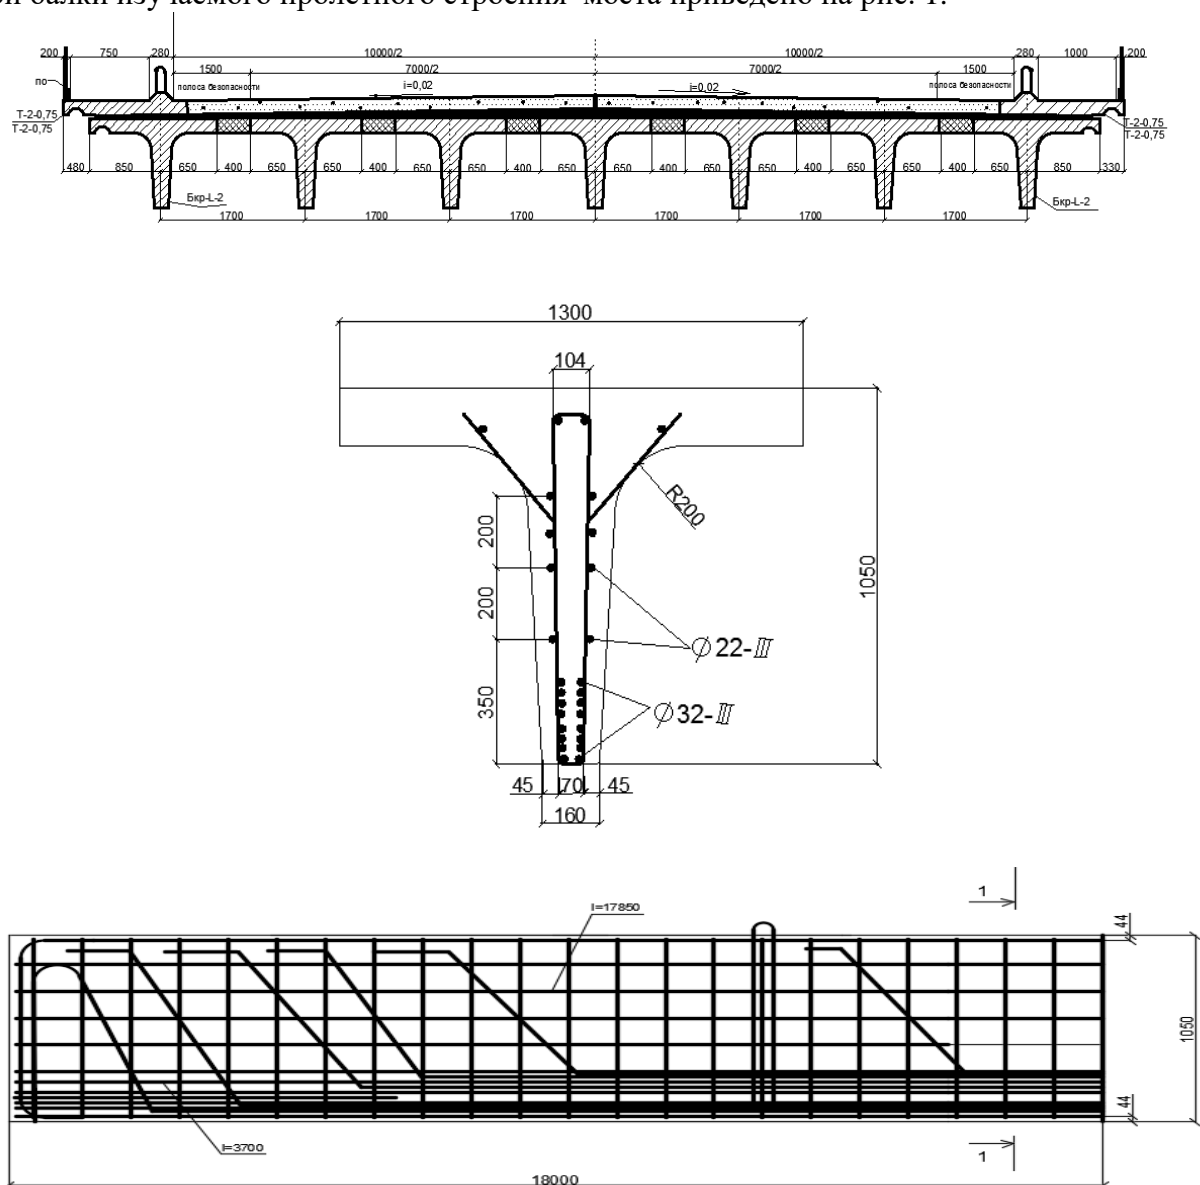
Поперечное сечение, продольный фасад и армирование главной балки изучаемого пролетного строения моста
